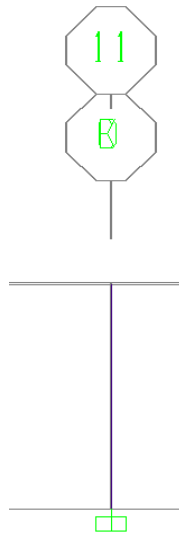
Empotramiento de columna, plano “xz” (SAP2000).
